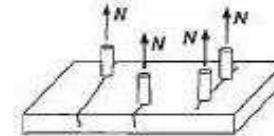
Falla por Fisuramiento [ 1 ]
